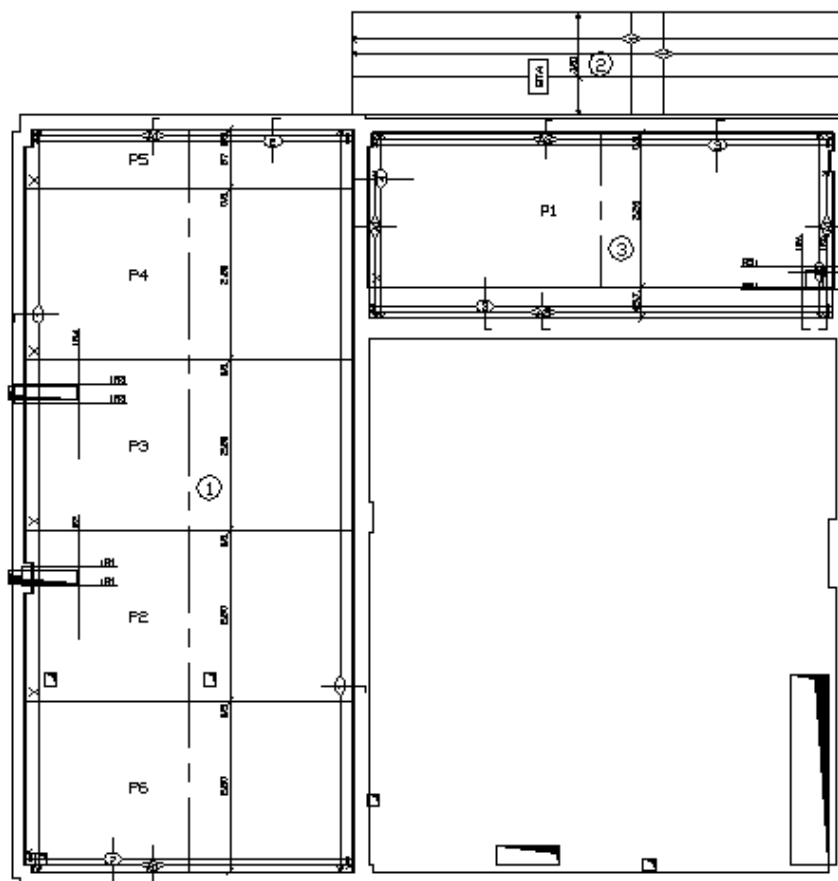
PLAN DE POSE DES PREDALLES POUR R+1
